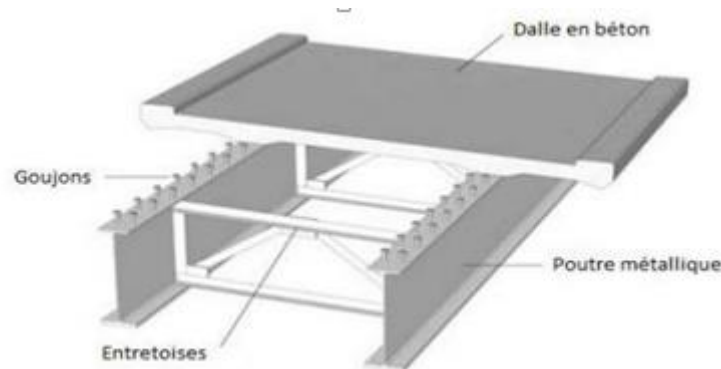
Connexion entre les poutres métalliques et la dalle
